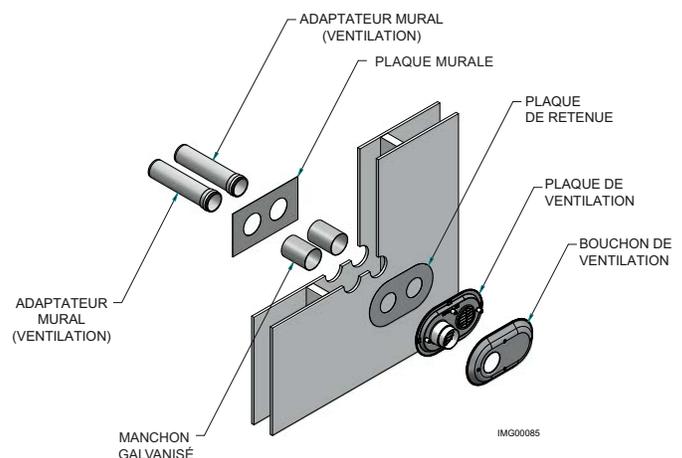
A Ensemble de terminaison murale en PVC/CPVC
